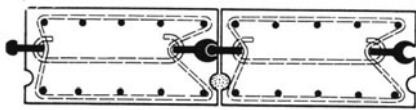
Eisenbeton-Spundbohle mit eisernem Schloß.
